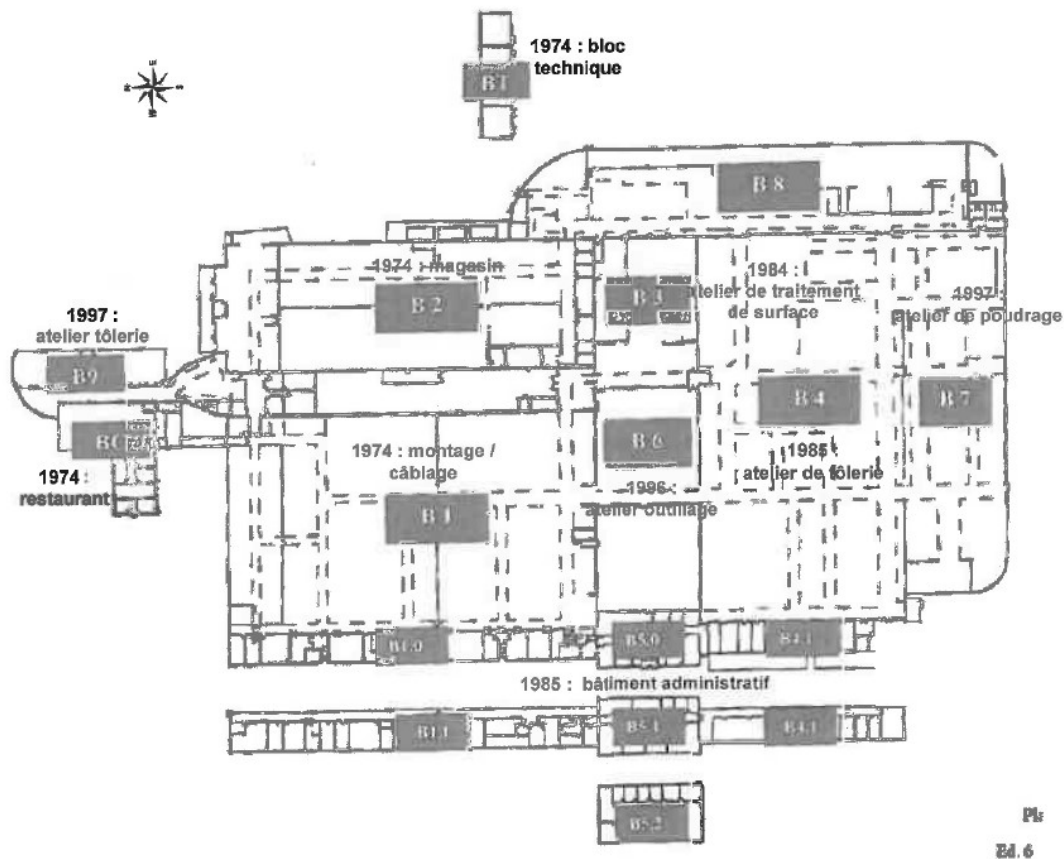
Plan de localisation des constructions historiques (sans échelle).
